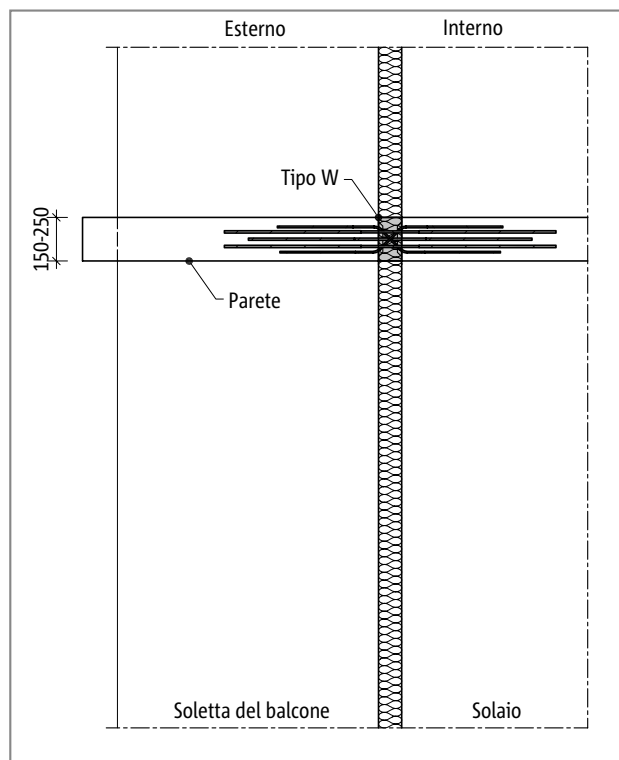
Schöck Isokorb® tipo W, pianta del prodotto
